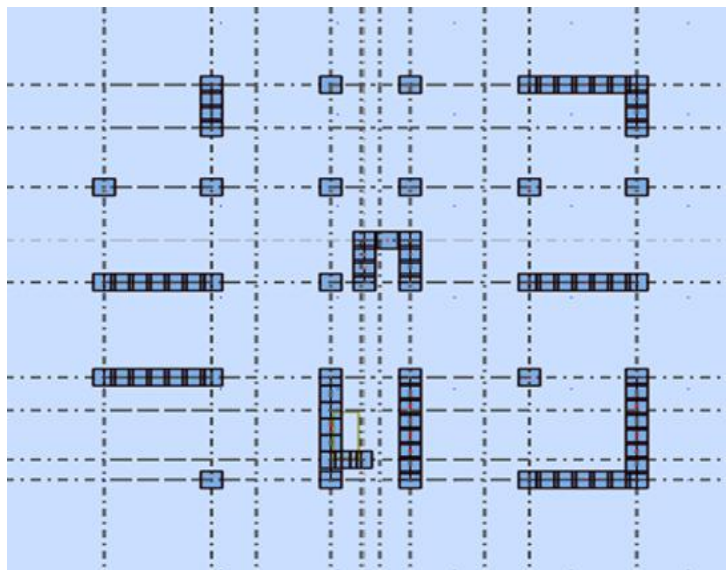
Vue en 2D et plan de la deuxième variante.
